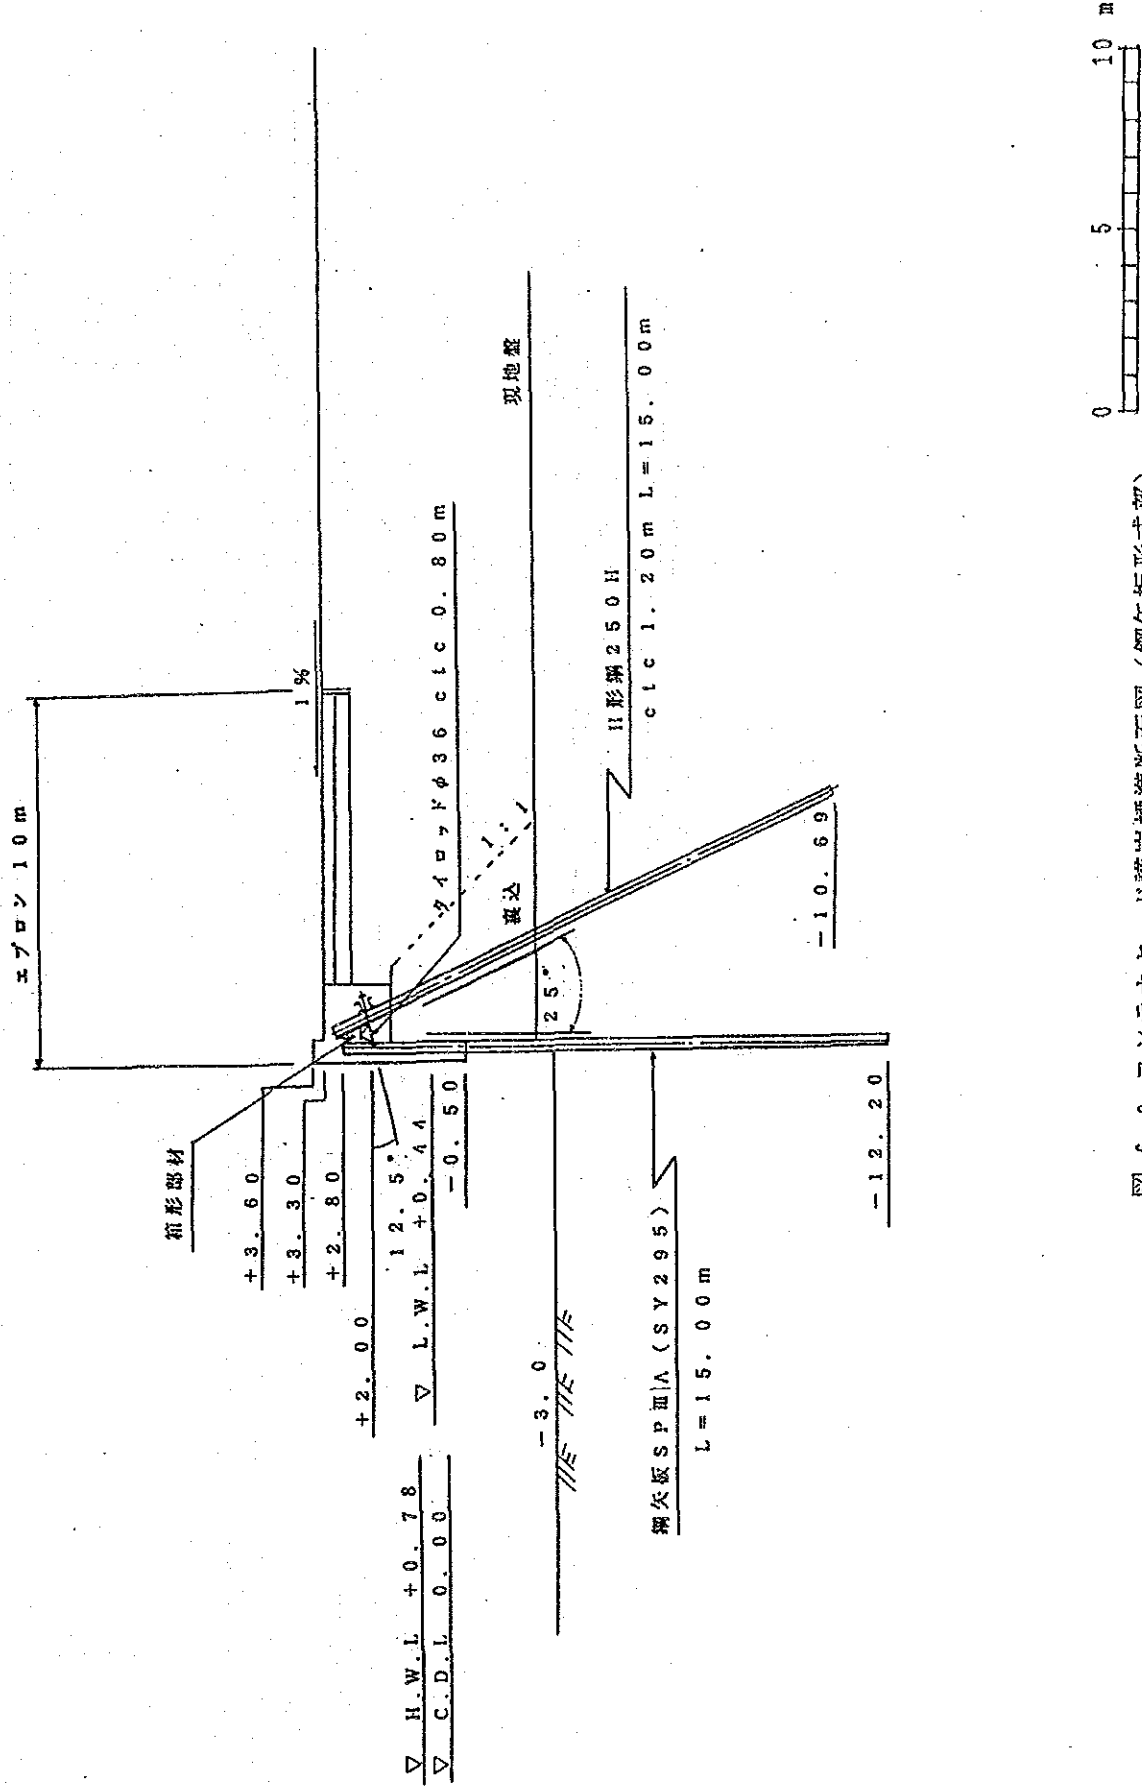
コンテナヤード護岸標準断面図 (鋼矢板形式部)
